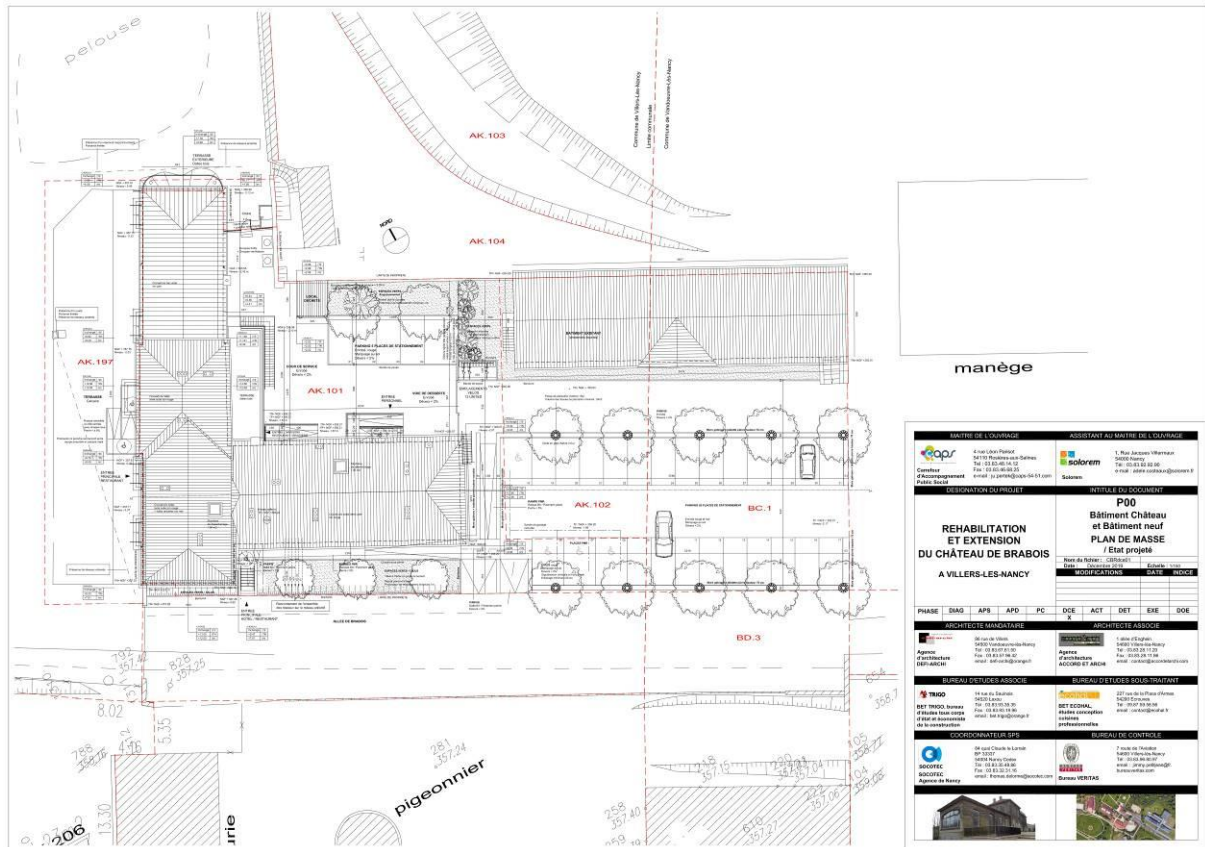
Plan d'aménagement final du château de Brabois et des ses annexes
